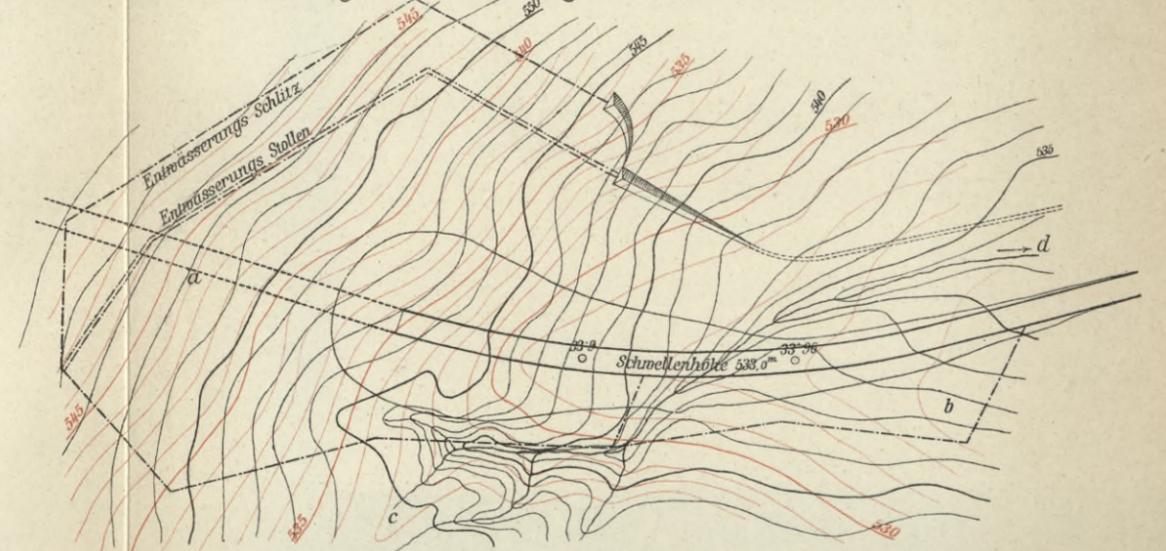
Darstellung der unterirdischen wasserleitenden Schicht durch Schichtlinien (Mehburger Tunnel der ungarischen Ostbahn) M. 1:2000.
